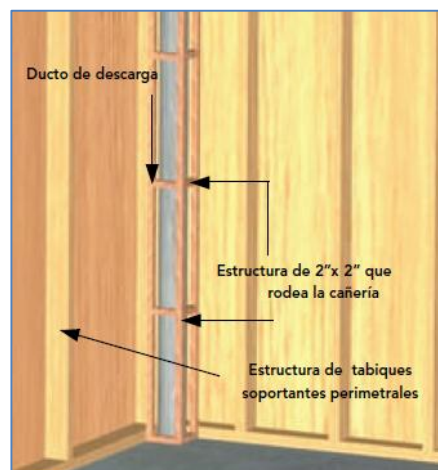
La cañería baja en una esquina a la cual se adosa una estructura de madera que será revestida quedando oculta, aparentando un pilar
